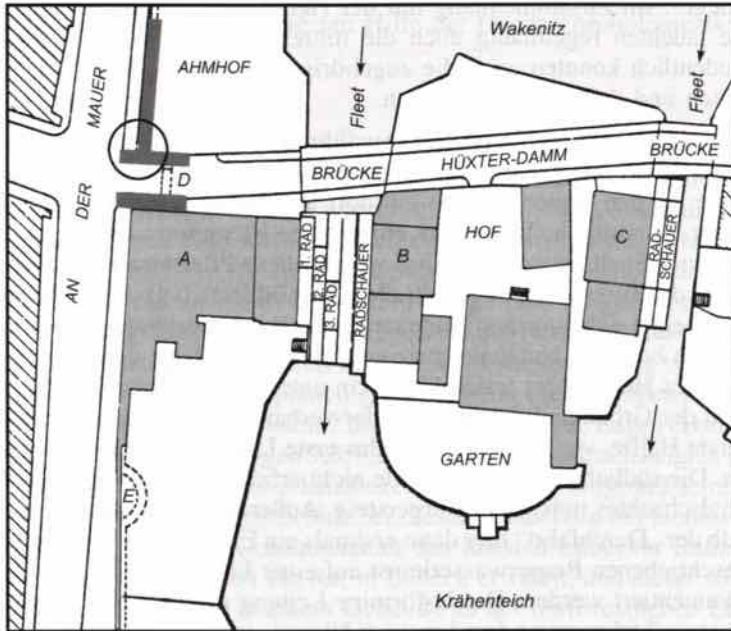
Lageplan der Wasserkünste auf dem Hüxterdamm um 1868²¹:
